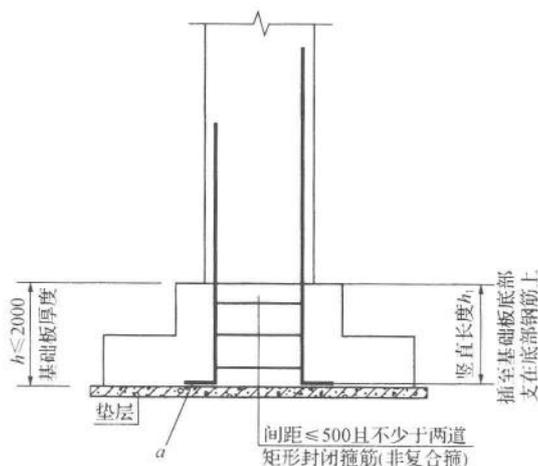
柱插筋在基础平板的锚固构造示意图(基础板底部与顶部配置钢筋网)
